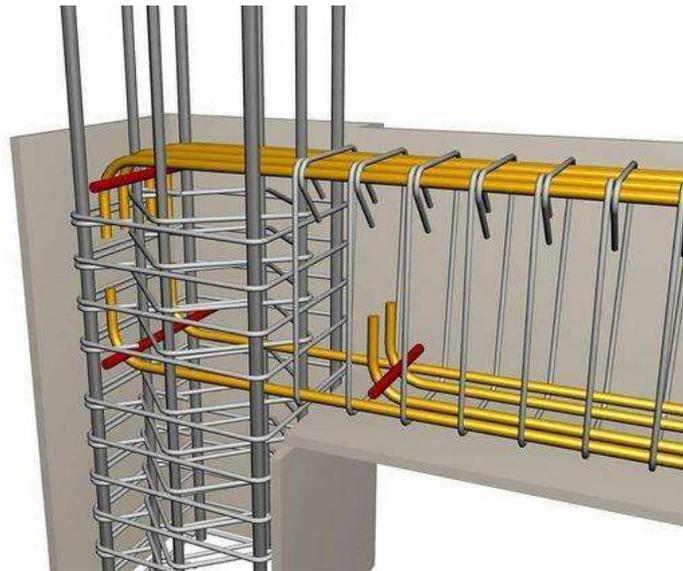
Elementos estructurales de concreto armado, tomada de Pinterest,
